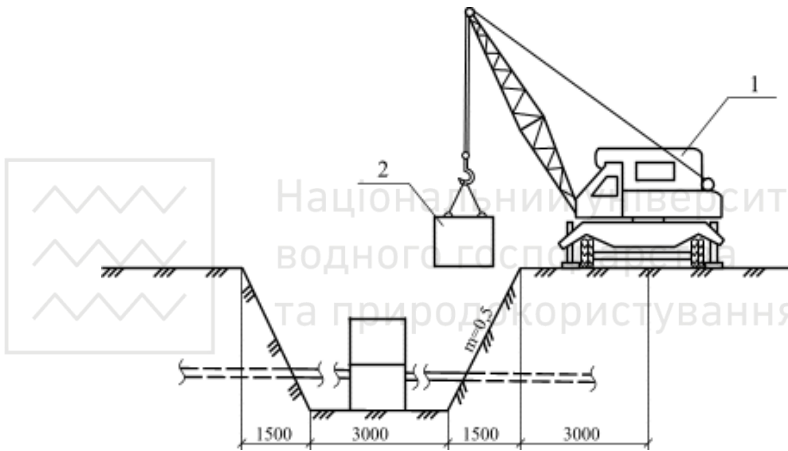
Демонтаж плити перекриття і верхнього стінового кільця за допомогою крану КС-2561. 1 – кран КС-2561; 2 – кільце, що демонтується
